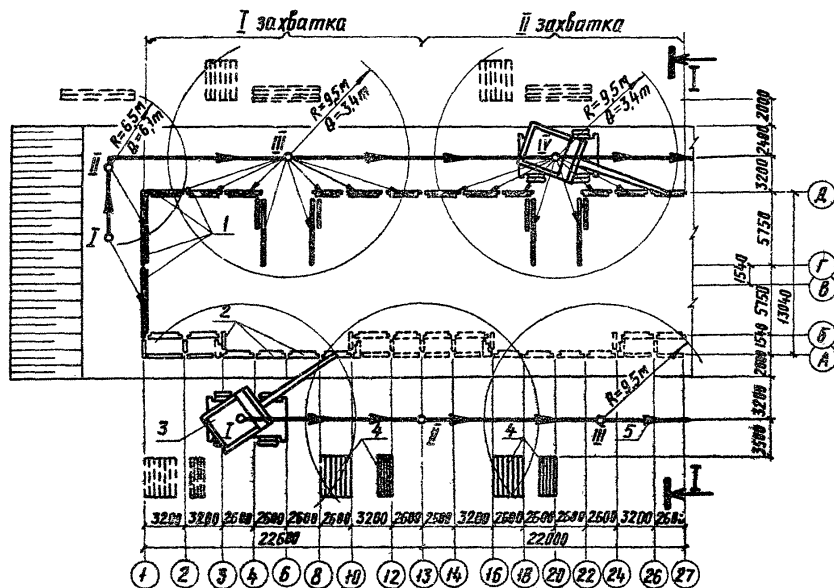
Схема организации работ по монтажу поковых стеновых панелей:
